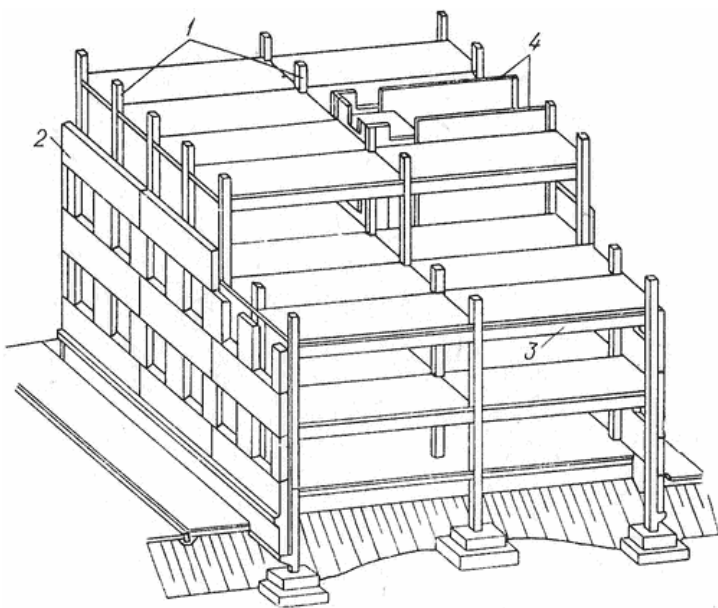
Будівля з повним каркасом: 1 – колони; 2 – навісні стіни; 3 – ригелі; 4 – стіни сходової клітки
